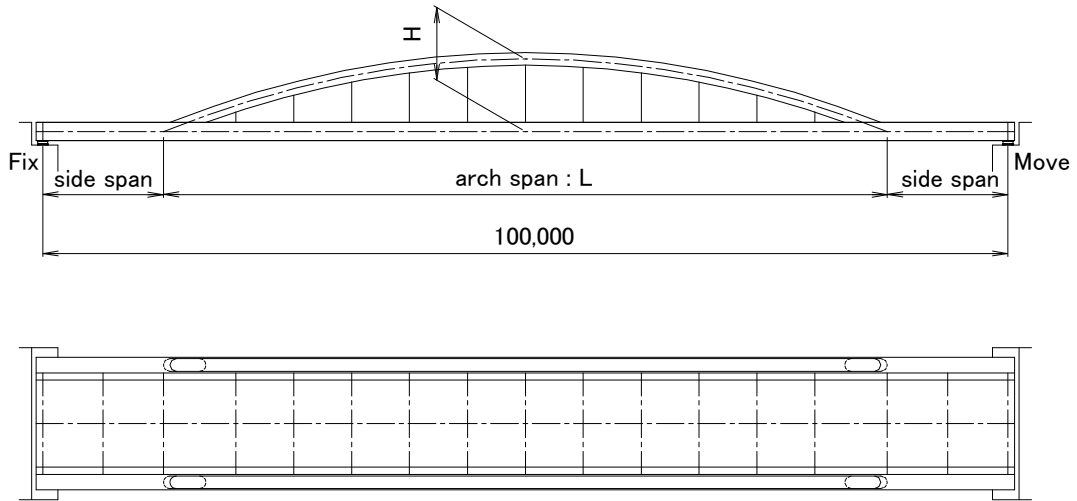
CFT 補剛アーチ橋 側面図 (mm)
